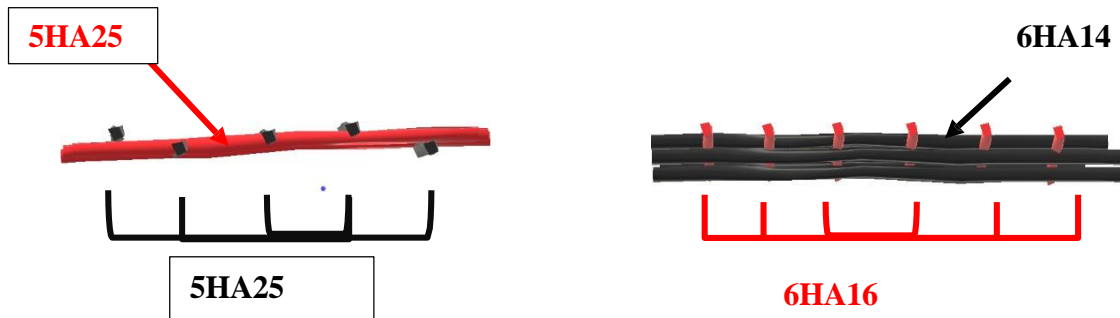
Ferrailage dans le sens transversal/longitudinal
